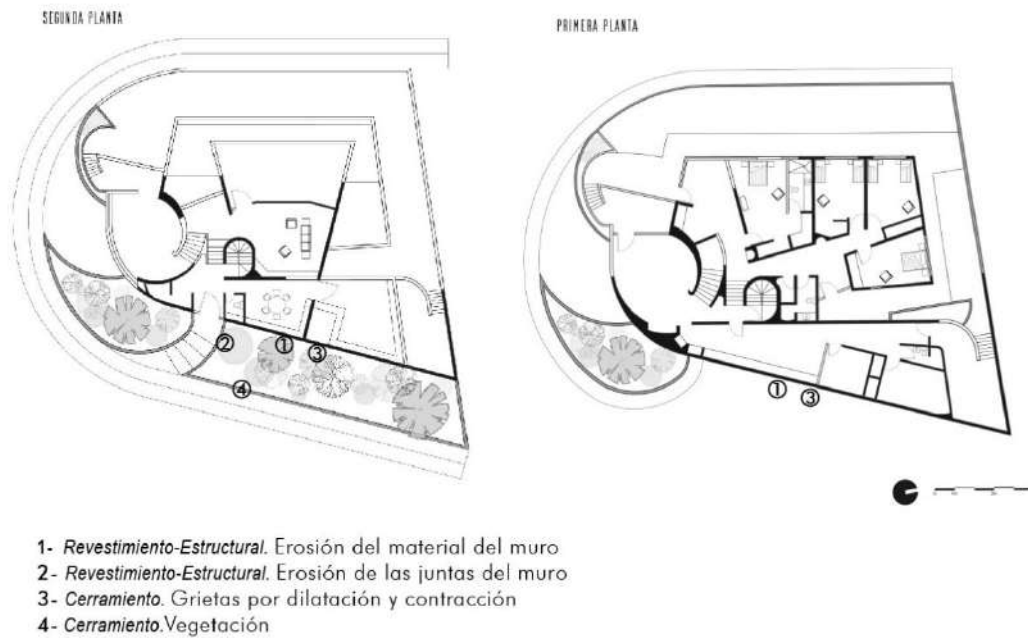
Localización de patologías en planta Casa Calderón. Edición: La Autora (2021).
